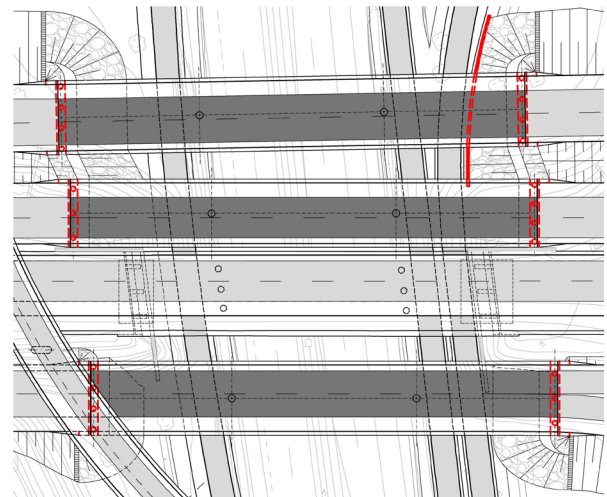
Estructuras E-10, E-11 y E-12. Planta
